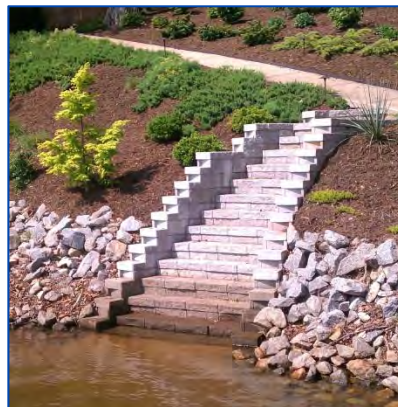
Exemple d'escaliers (source : Renegar construction [www.renegarconstruction.com])
